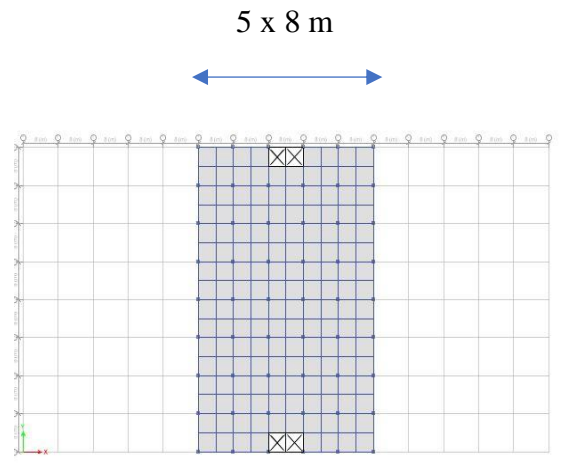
Denah Lantai 1 - Lantai 2 Model A1
